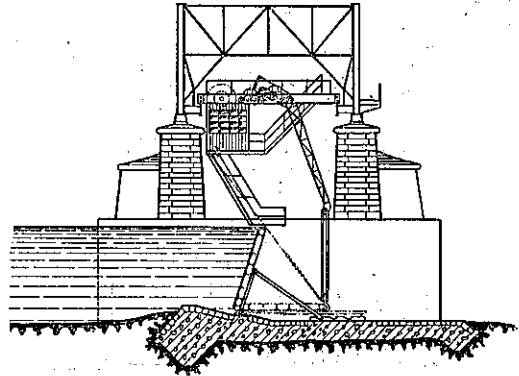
Vives Eaux 堰 (Chanoine-Pasqueau)
